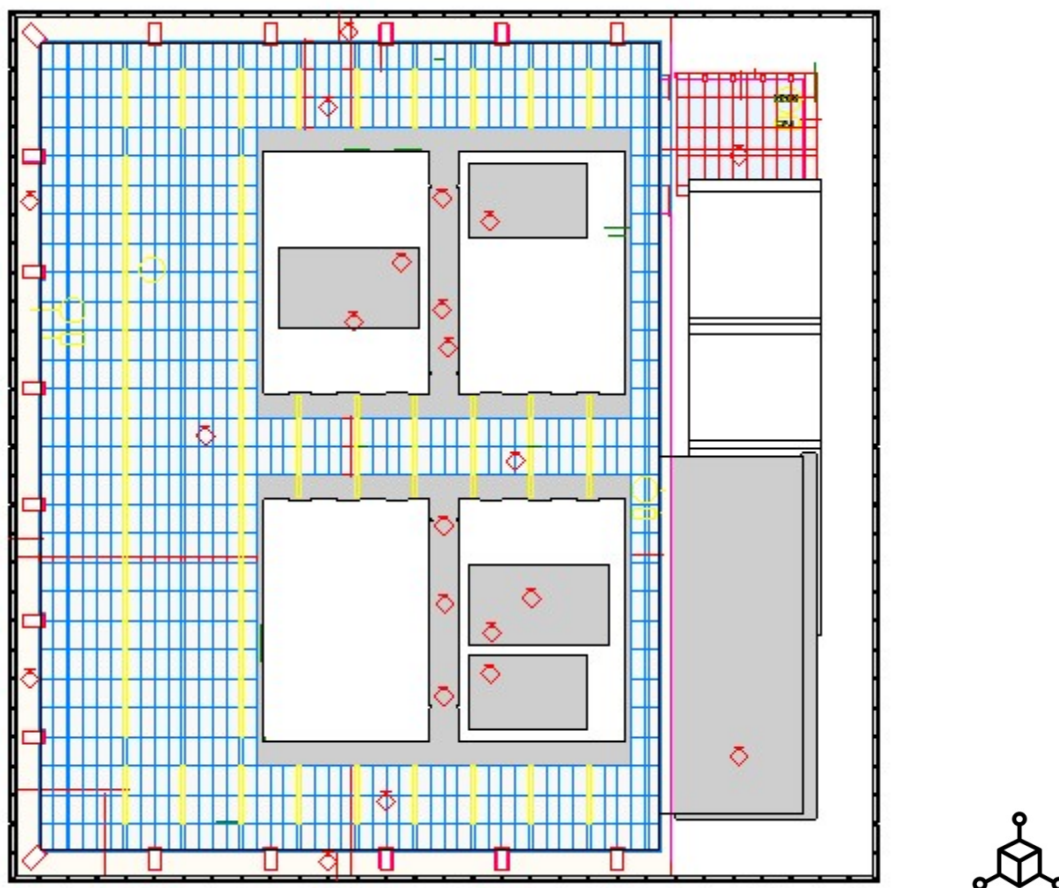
Pianta controsoffitti piano trentesimo (fuori scala).
